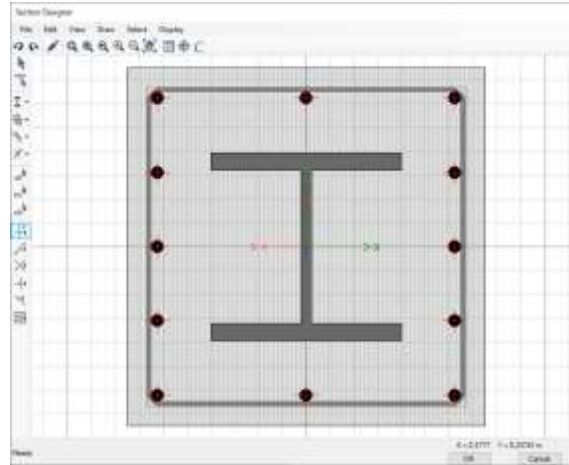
Definición de columna de 75x75 reforzada con perfil metálico H
